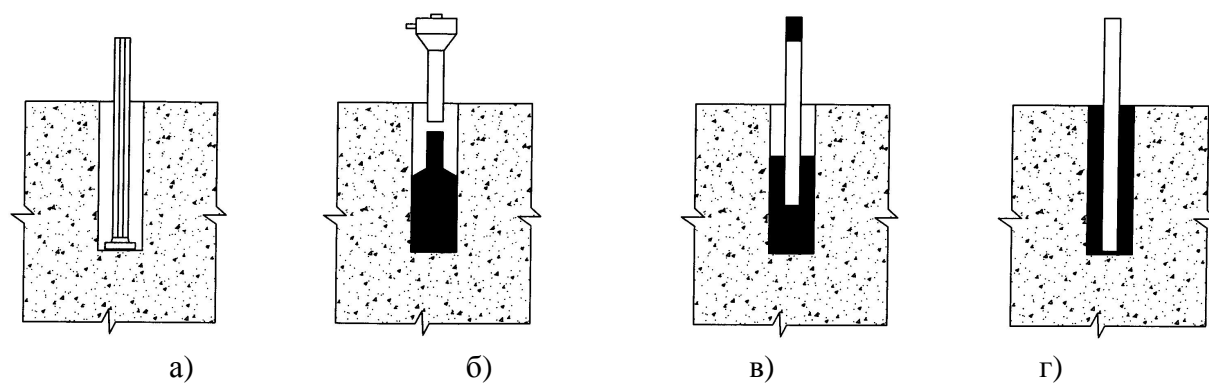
Установка арматурных стержней: а – бурение шпуров; б – заливка акрилового клея в шпур; в – установка арматурного стержня в шпур; г – установка арматурного стержня в проектное положение
